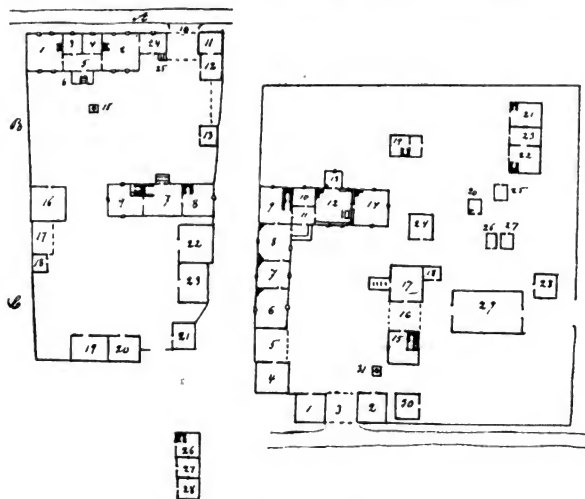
Grundriss eines tawastländischen Bauerhofes. Renko. Tawastehus.
